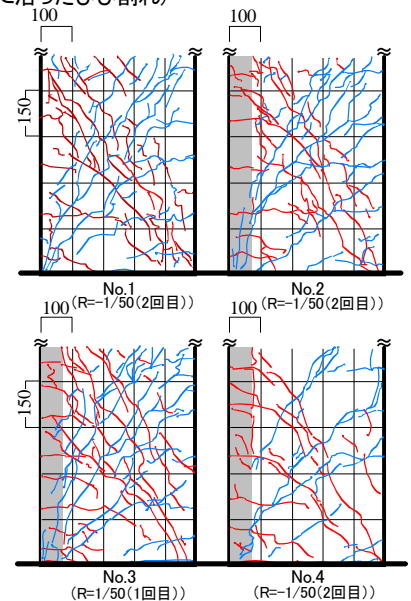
ひび割れ状況図 (載荷方向に対して側面)
